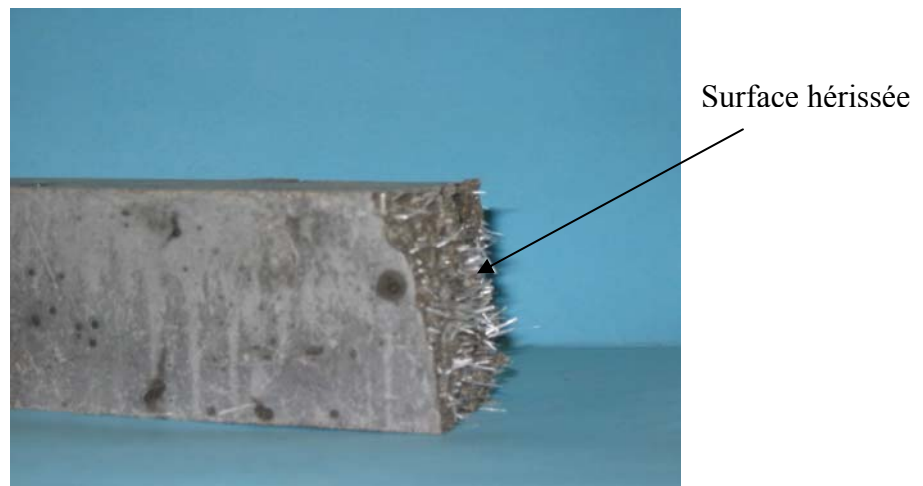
Image montrant des fibres déchaussées à la suite d'un essai de flexion
